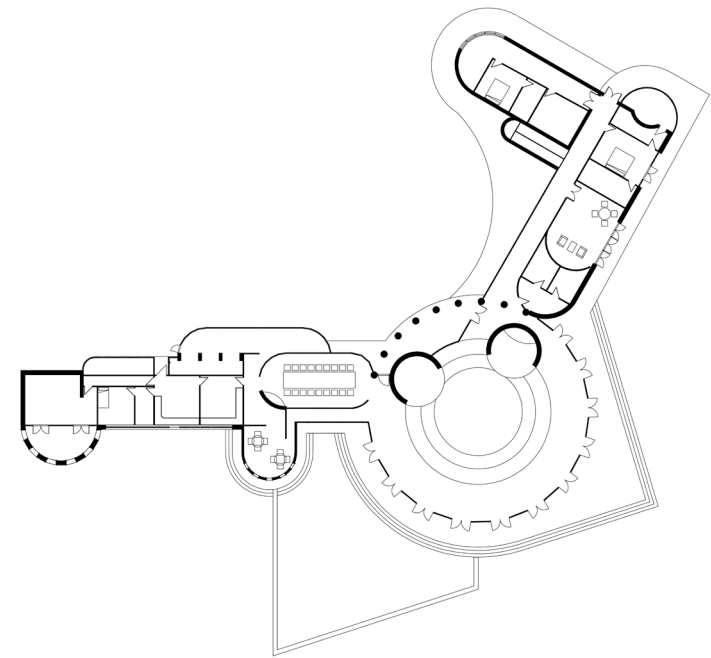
Casa Crownfield. Planta baja. Dibujado a partir de los planos originales.
